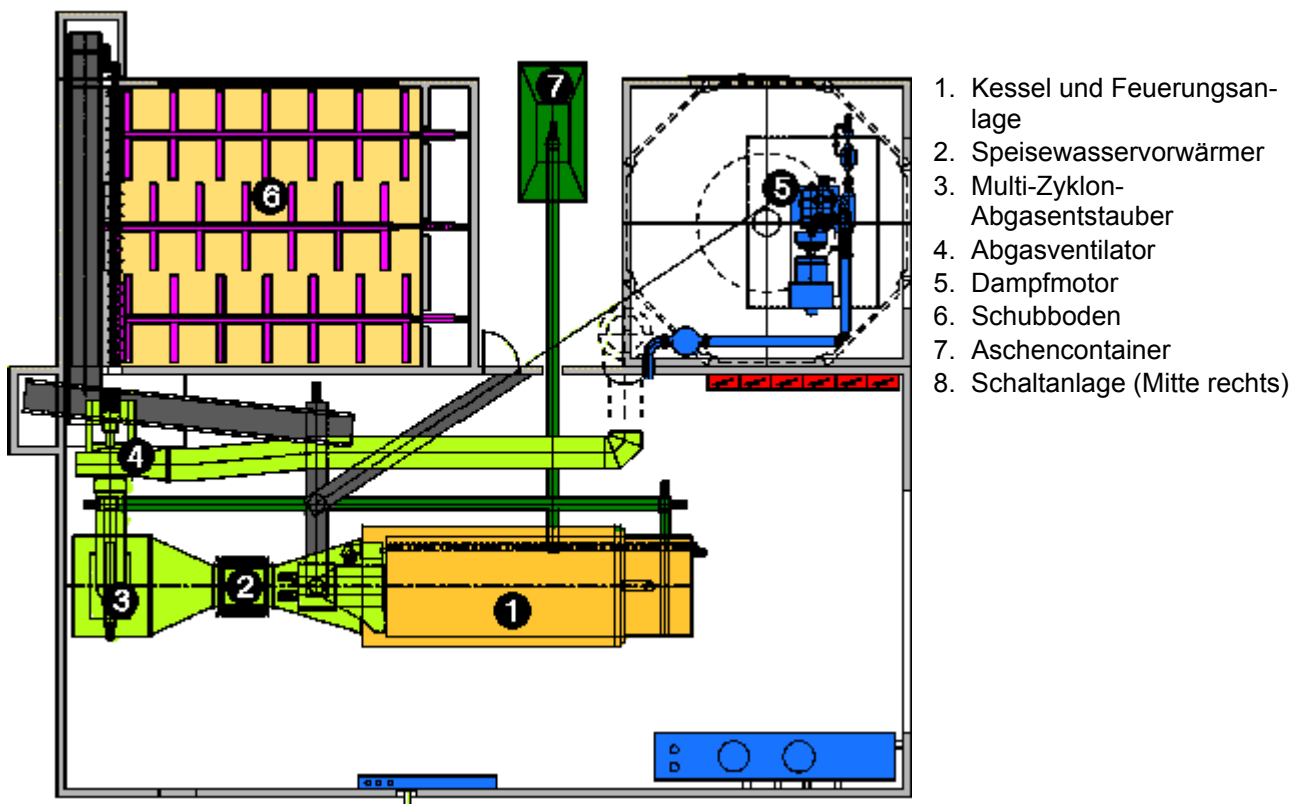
Grundriss Heizzentrale Lengwil mit Rinden und Trockensilo.
